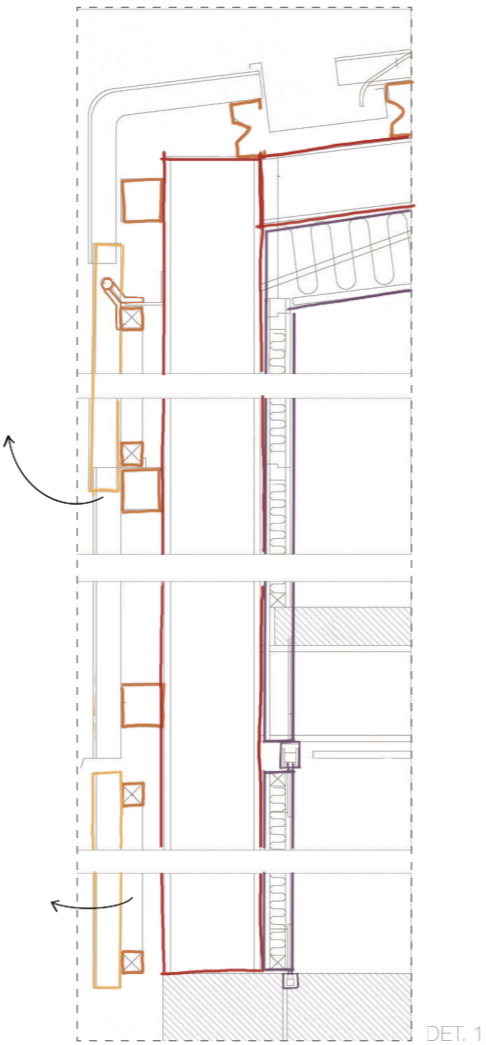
Detalle constructivo de la fachada norte (fachada calle) y cerramiento de la caja aislada de madera. Este detalle es asimilable al detalle constructivo de la envolvente del invernadero. La técnica de unión y soluciones móviles se repiten en todo el proyecto.
